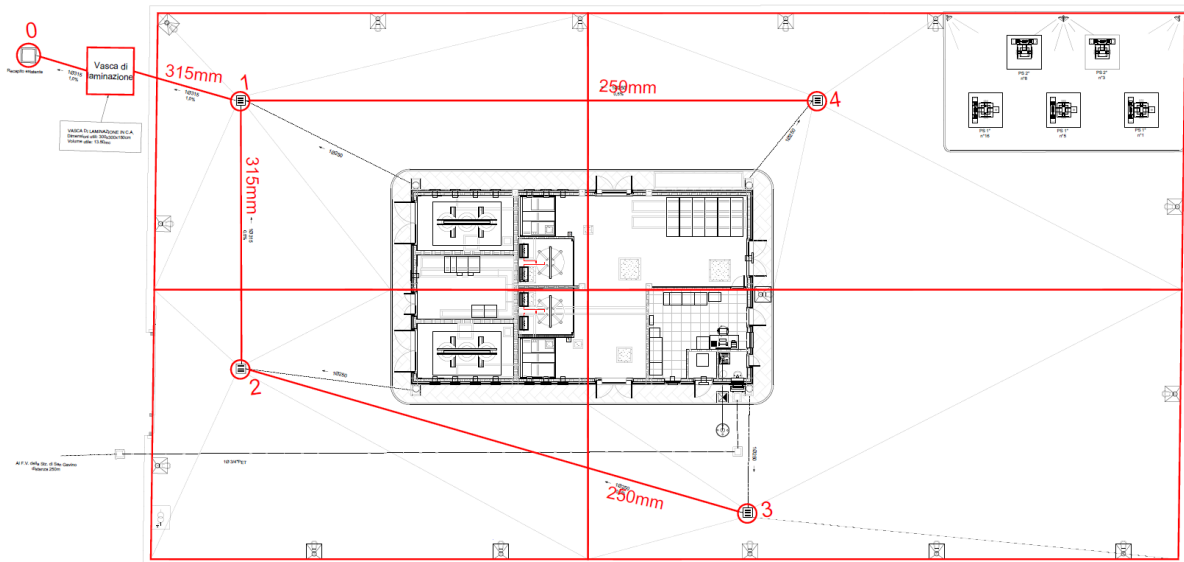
Stralcio planimetro della rete di drenaggio adottata per il piazzale.
